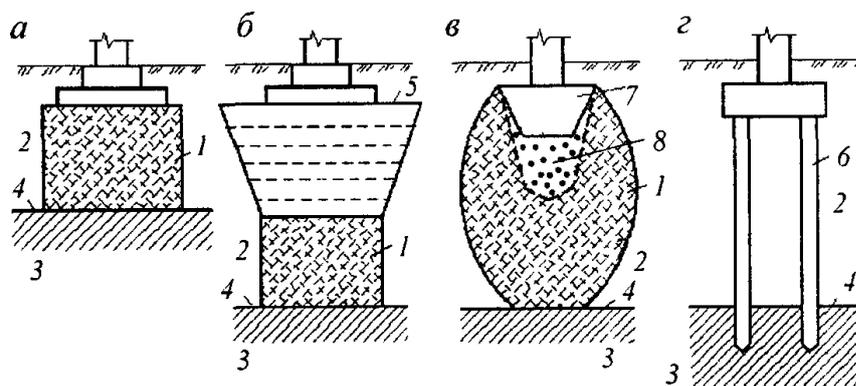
Различные варианты устройства оснований и фундаментов в грунтовых условиях I типа просадочности: 1 - уплотненный грунт; 2 - просадочный грунт; 3 - непросадочный грунт; 4 - нижняя граница просадочного грунта; 5 - грунтовая подушка, уплотненная послойно; 6 - сваи; 7 - набивной или забивной фундамент, пирамидальная короткая свая; 8 - щебень, втрамбованный в грунт
